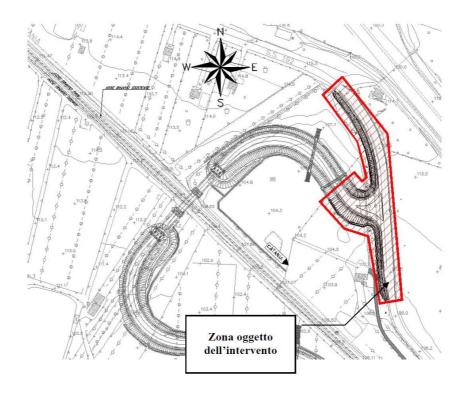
Stralcio Planimetrico intervento oggetto di variante
